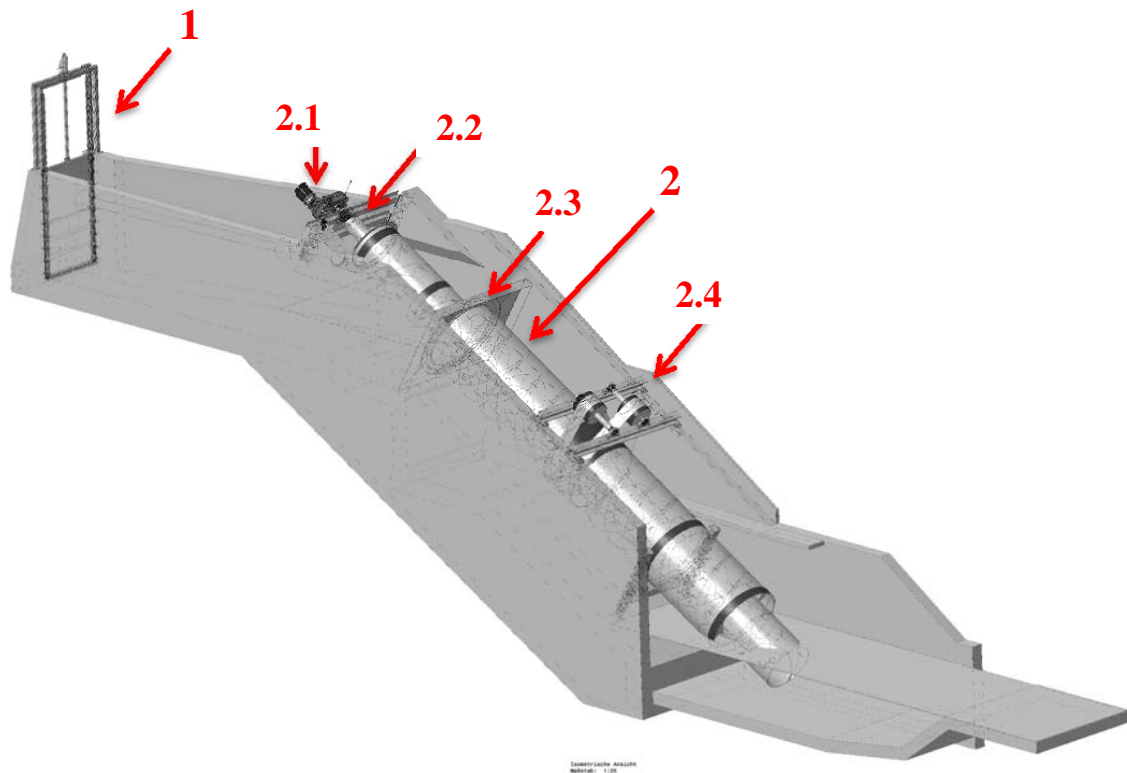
HYDROCONNECT Drehrohr-Doppel-Wasserkraftschnecke
